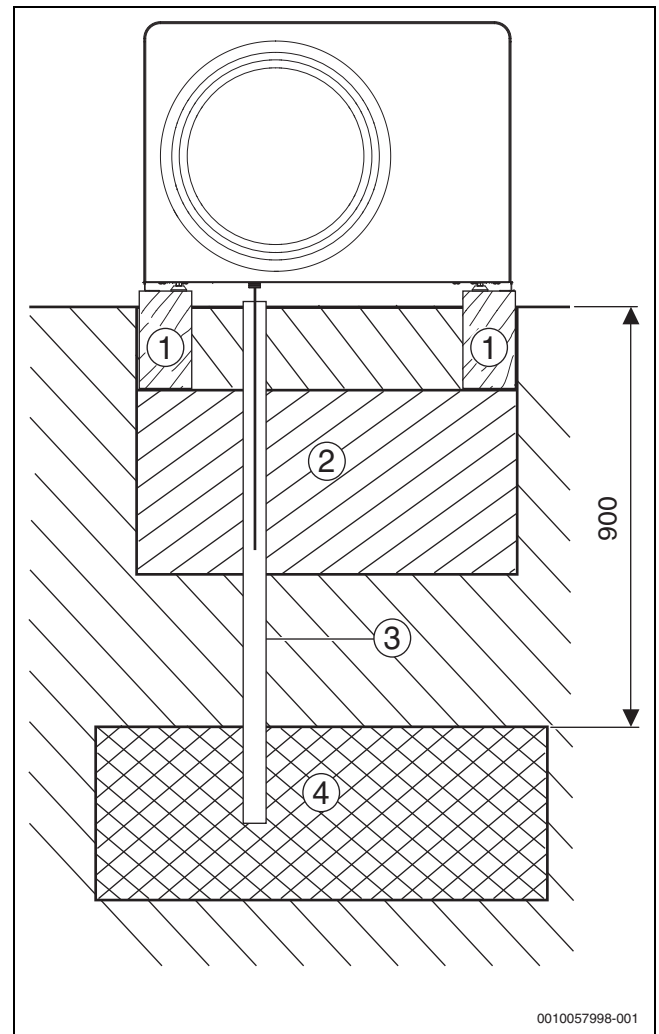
Kondensatableitung in Kiesbett (Maße in mm)
